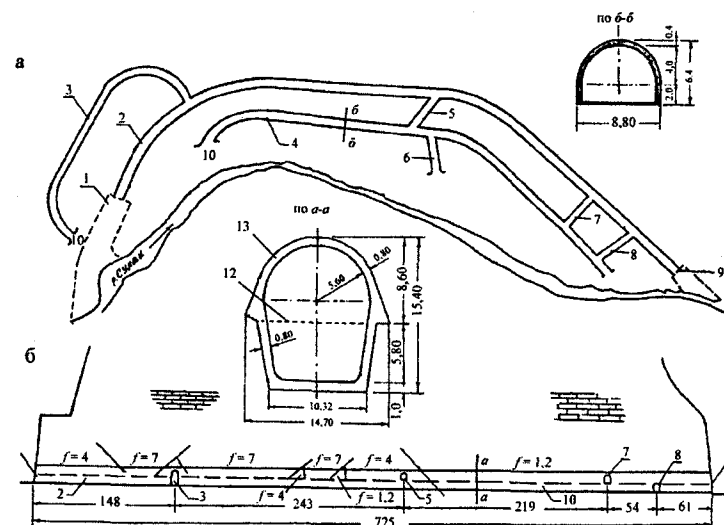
Схема проходки строительного тоннеля на Чиркейской ГЭС: а – план тоннеля, б – геологический разрез по трассе тоннеля: 1 – входной портал, 2 – строительный тоннель, 3,5,7,8 – подходные выработки, 4 – транспортный тоннель; 6 – тоннельный въезд в котлован плотинки; 9 – низовой портал; 12 – граница верхнего уступа; 13 – бетонная обделка
